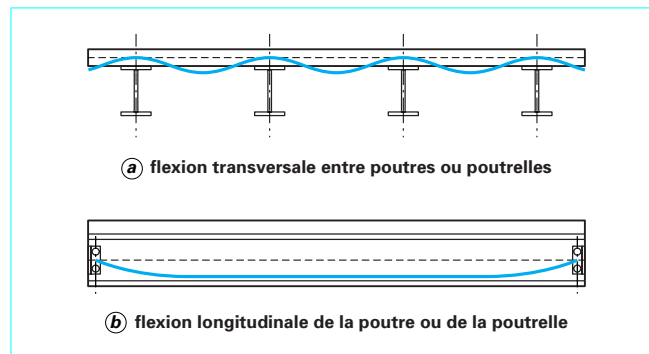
Flexion transversale et flexion longitudinale d'un plancher
